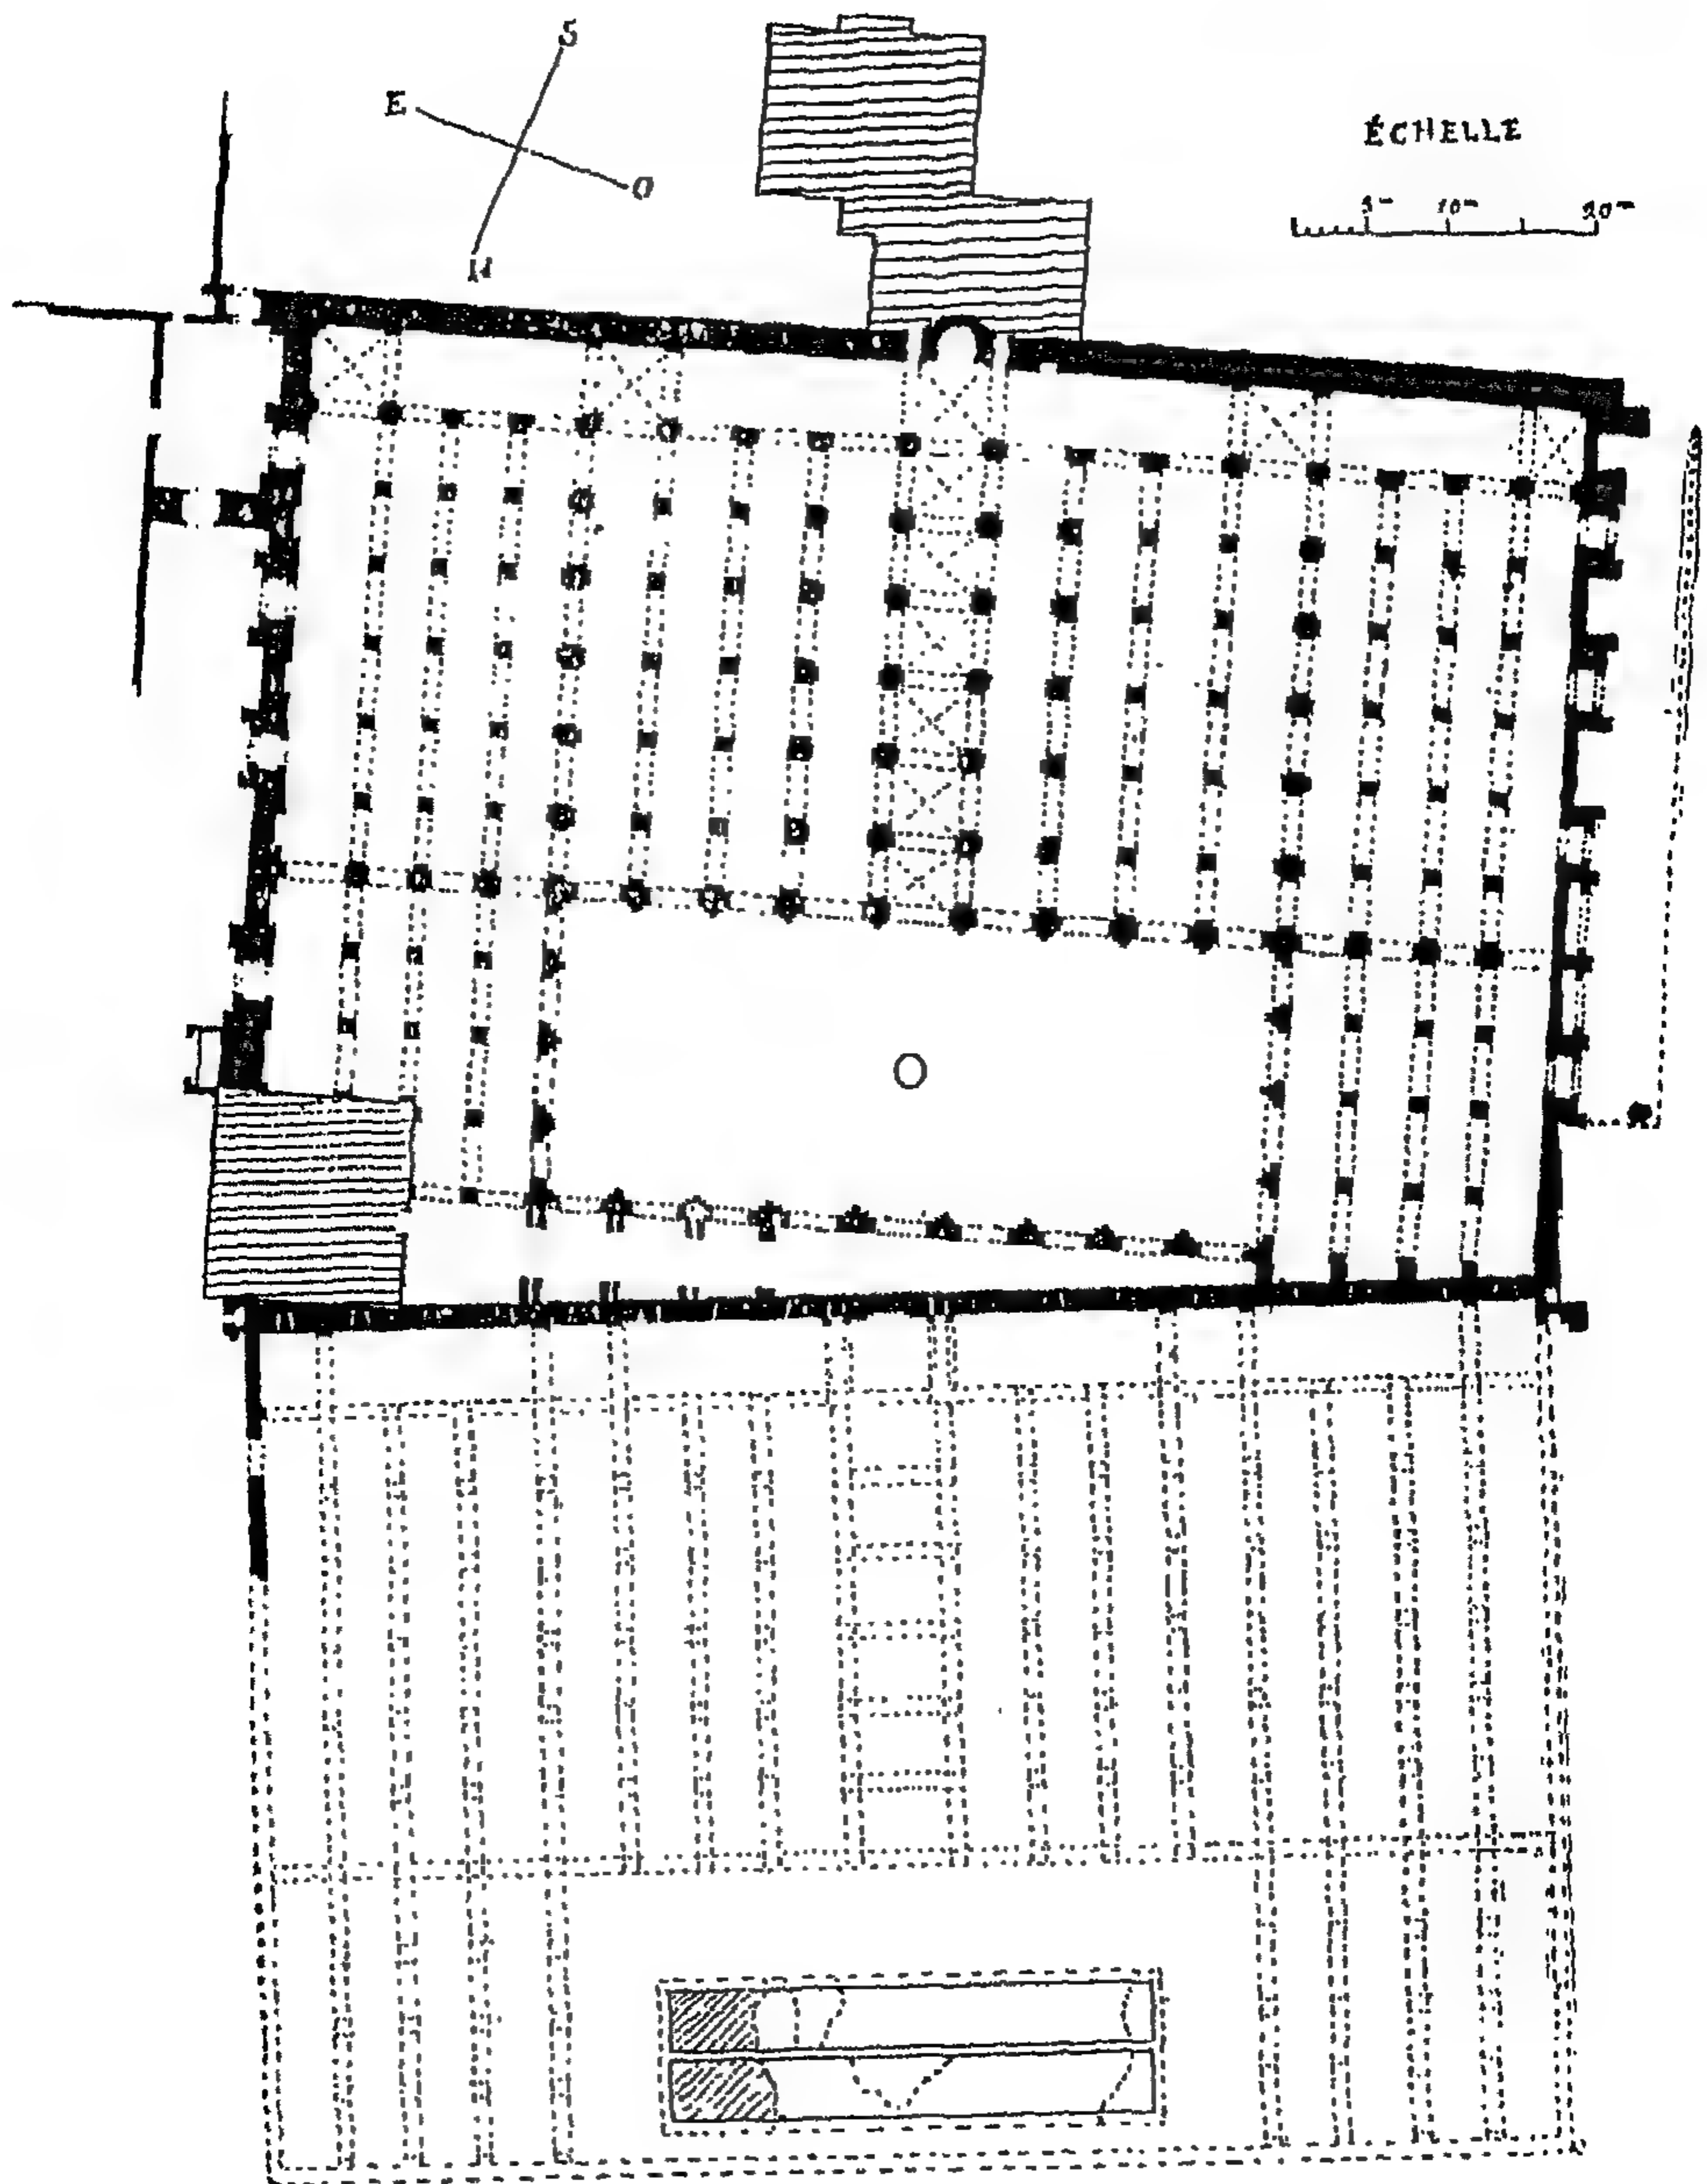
مسقط أفقي لجامع القرويين بفاس
